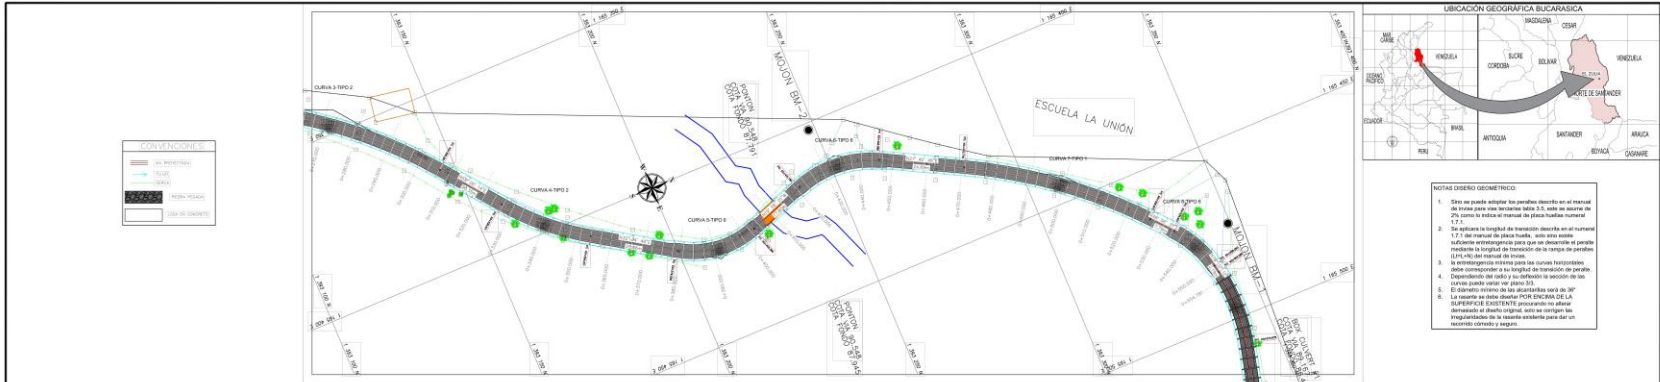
Vista en planta y perfil de la sección transversal en curvas TIPO 1 Δ ≤ 150° y R > 150 m
